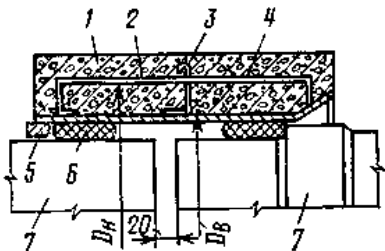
Стыковое соединение железобетонных предварительно напряженных труб железобетонной муфтой с металлической обечайкой: 1 – муфта; 2 – бетон марки 400; 3 – металлическая обечайка; 4 – спиральная предварительно напряженная арматура; 5 – замок (бург); 6 – резиновое кольцо; 7 – труба (размеры в мм)
